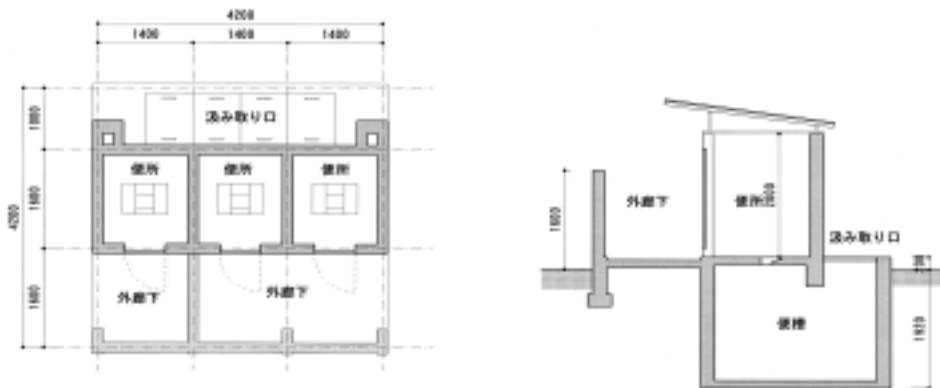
便所平面図・断面図(タイプ LB : 1 サイトに 2 棟以上設置する)
